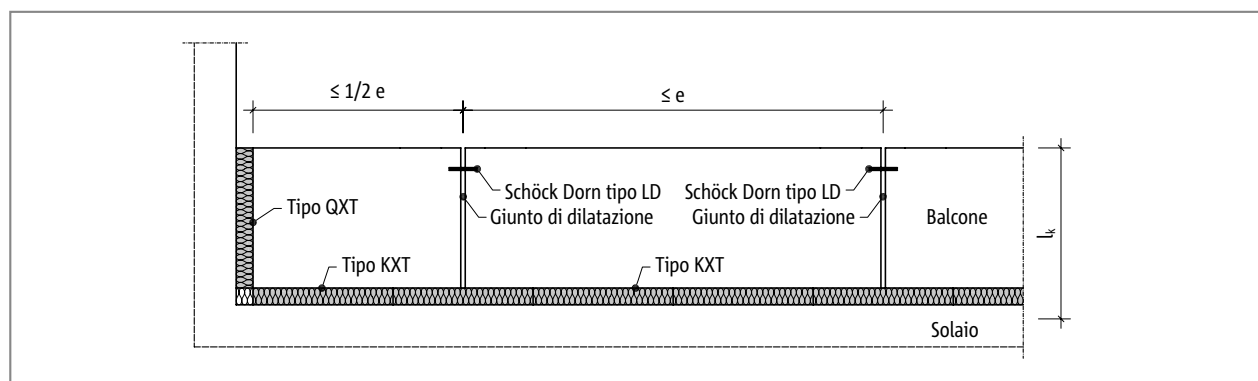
Schöck Isokorb® tipo KXT: disposizione dei giunti di dilatazione
